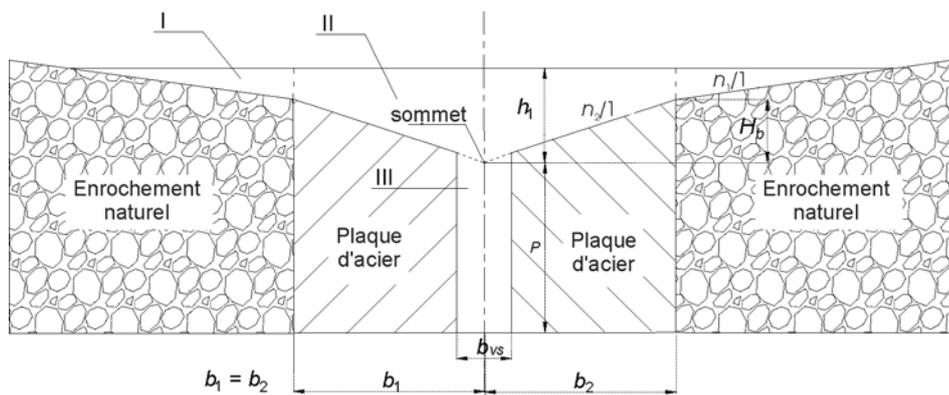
Coupe du seuil en forme de V avec fente verticale
